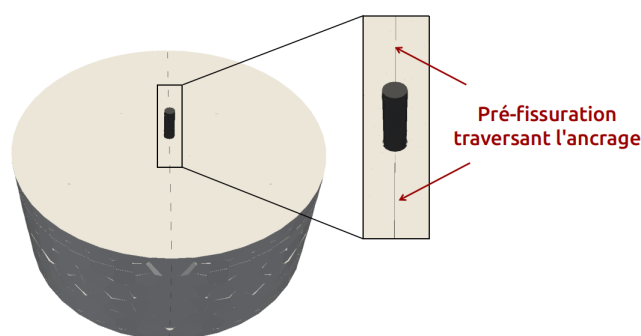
Ancrage installé dans un béton pré-fissuré (DEAP).
